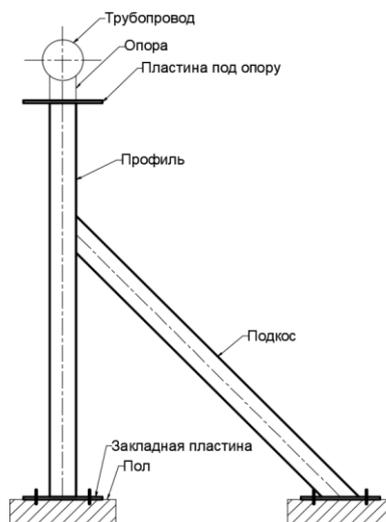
Подопорная металлическая конструкция - стойка с подкосом.
